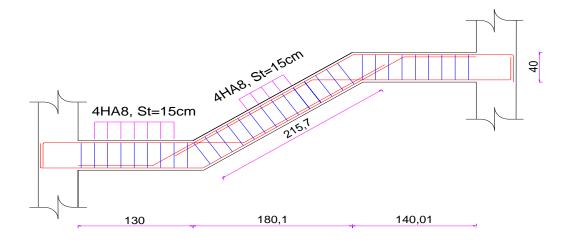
Schéma de ferraillage transversal de la poutre brisée
